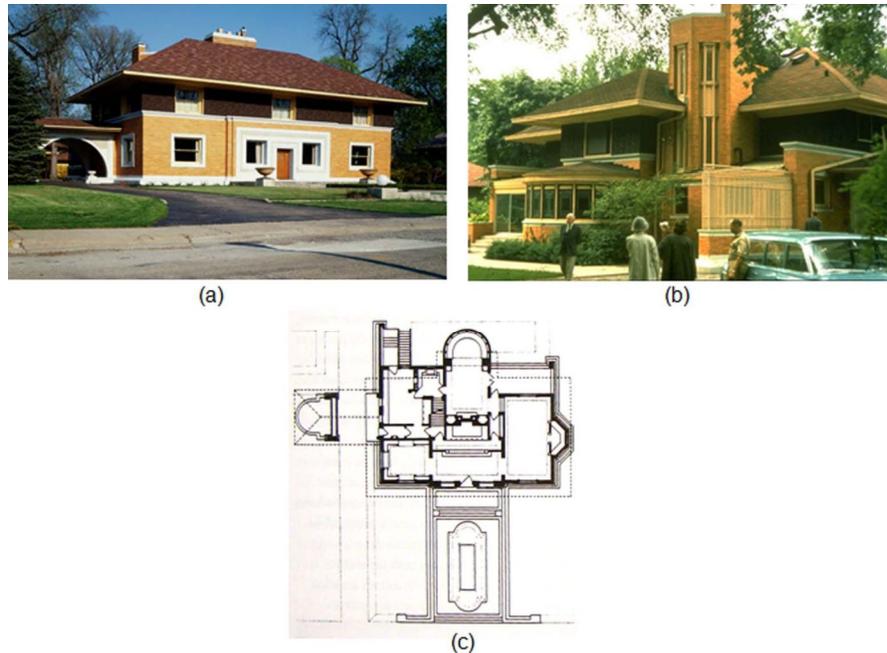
Frank Lloyd Wright, Casa Winslow, River Forest, Illinois, E.U.A., (1893): (a) Fachada principal, (b) Fachada posterior, (c) Planta arquitectónica (Planta baja).
